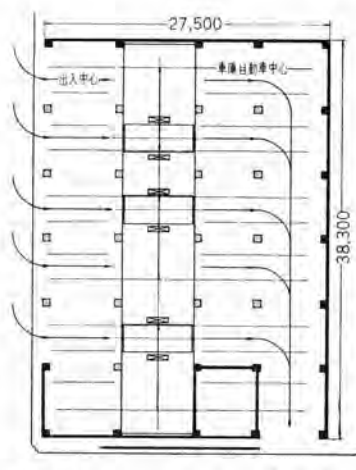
クレーン・エレベータ・ドーリ 式 1 階平面図
